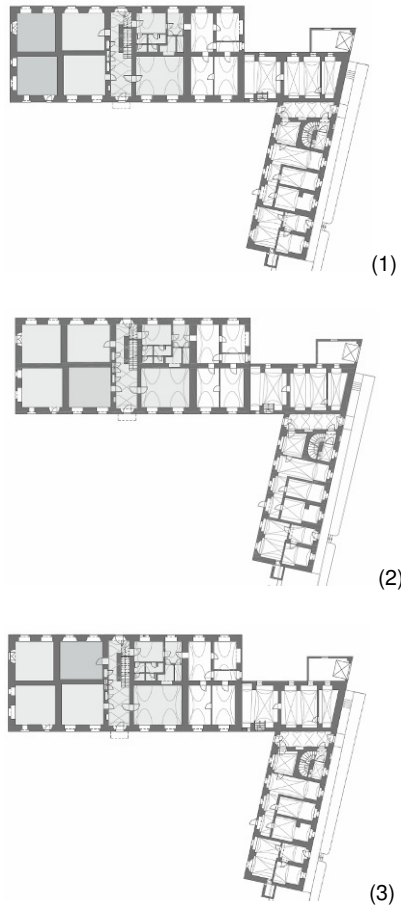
Die klein dargestellten Pläne (1) bis (3) zeigen wo die Räume auf den Bildern im Grundriss des Erdgeschosses situiert sind (siehe dazu Abb.30 bis 32)
